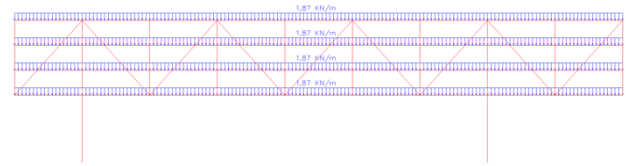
Esquema cargas permanentes lineales fachada norte.
